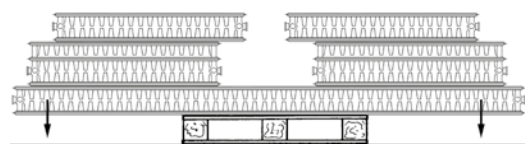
Falsche Lagerung führt zu Beschädigungen
